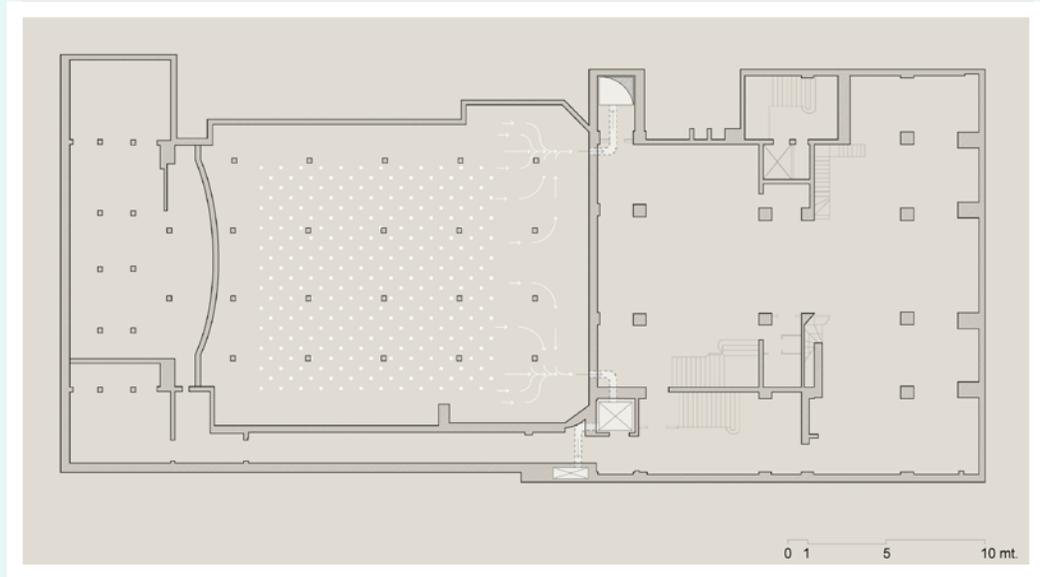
Reconstrucción del sistema de aire acondicionado del Teatro Real. Planta del subterráneo. Elaboración propia en base a la identificación en terreno de admisiones de aire, al levantamiento arquitectónico y a las patentes US1583060A Pat.Ch. 7517-1930.
